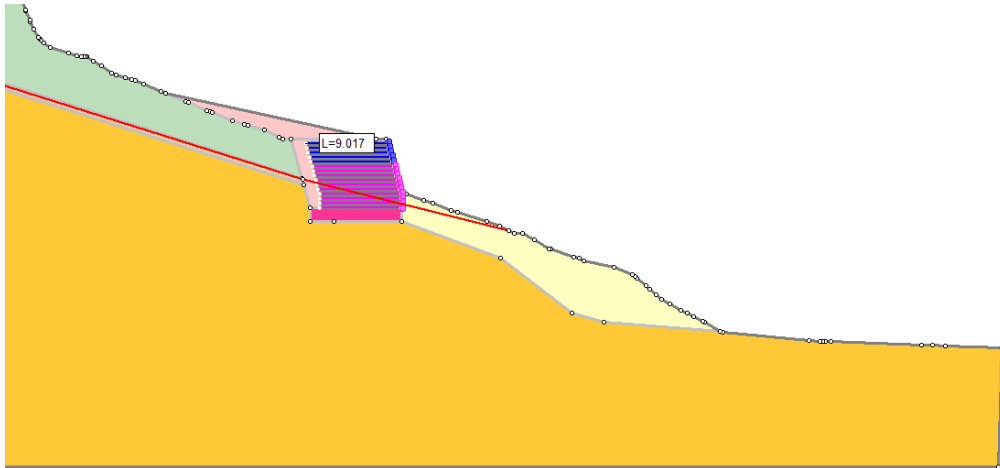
Modelo con muro en tierra armada perfil 3
